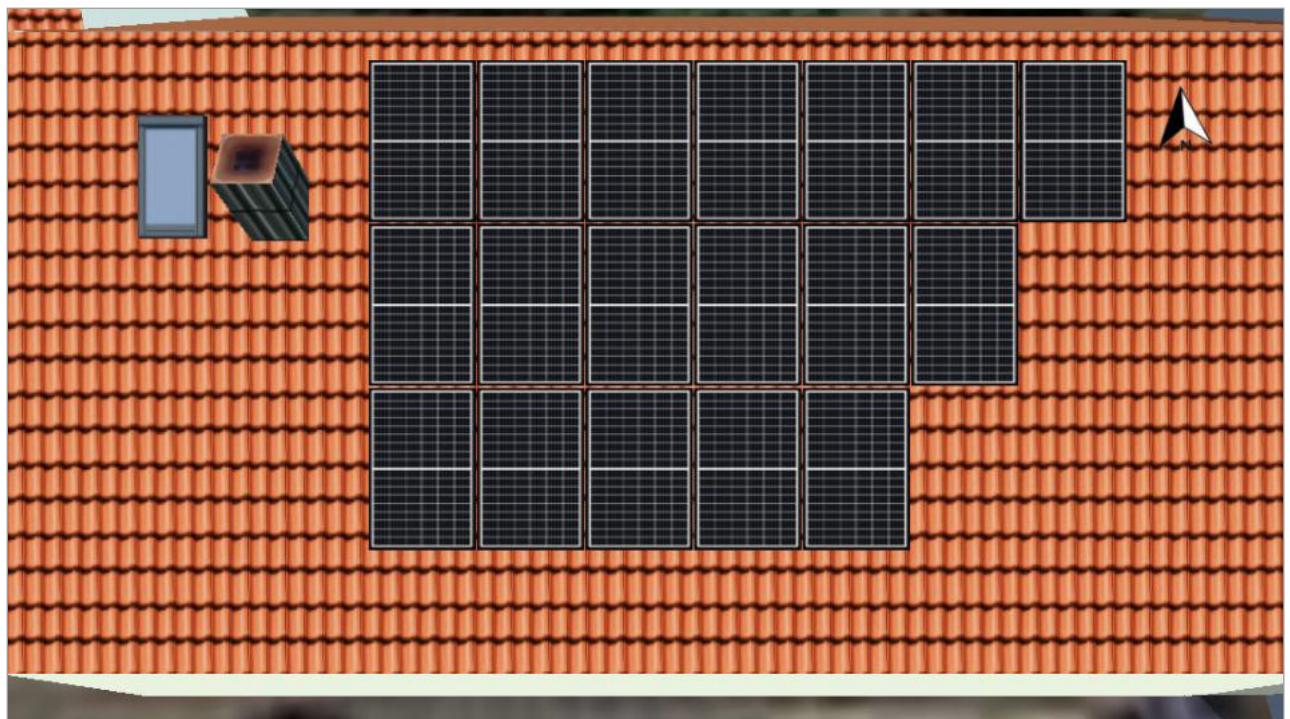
Modulfläche - Gebäude 02-Dachfläche Süd
